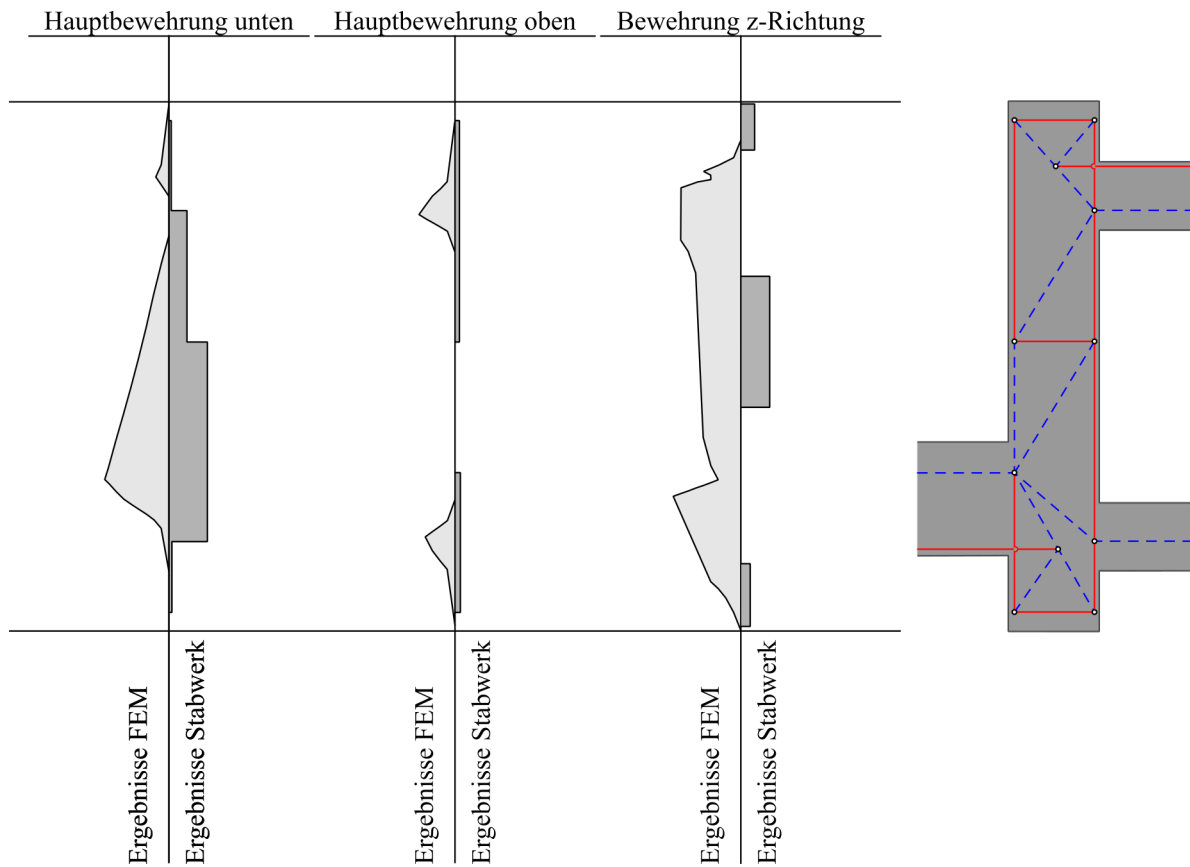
Variante 2 Lastfall 2-Bewehrungsvergleich
